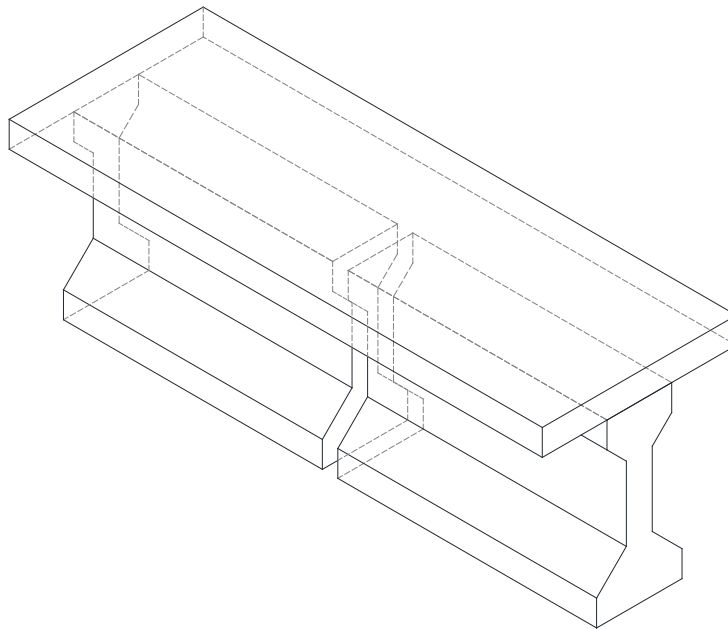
Detalle en el que se muestra un segmento de la superestructura del puente, en el que se observa la junta de dilatación entre las traveses y la losa de cubierta continua, empleando losas de conexión. Modelo 2
